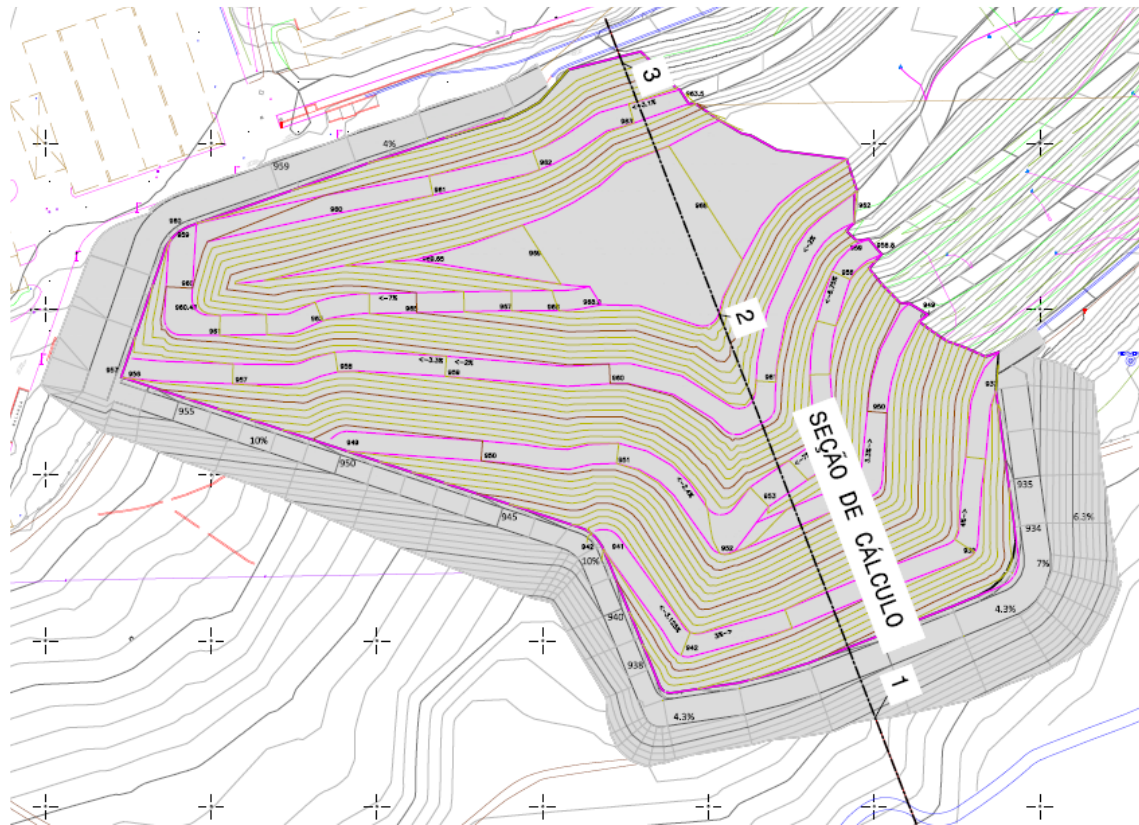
Planta modelo de preenchimento célula. Secção de cálculo.
